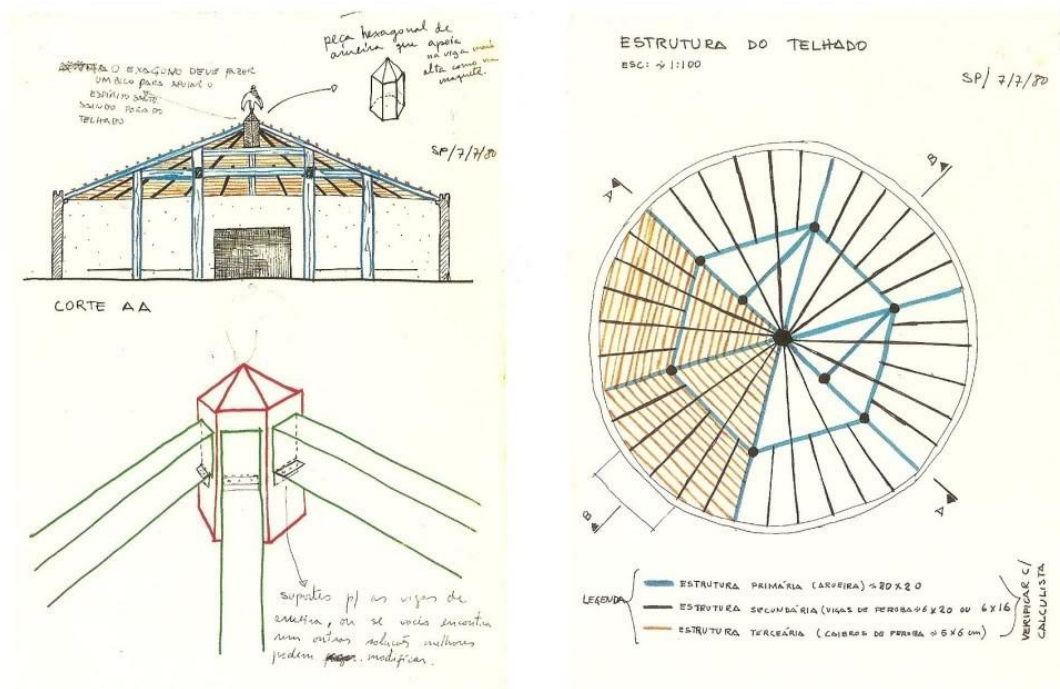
Croqui cobertura – Espírito Santo do Cerrado
